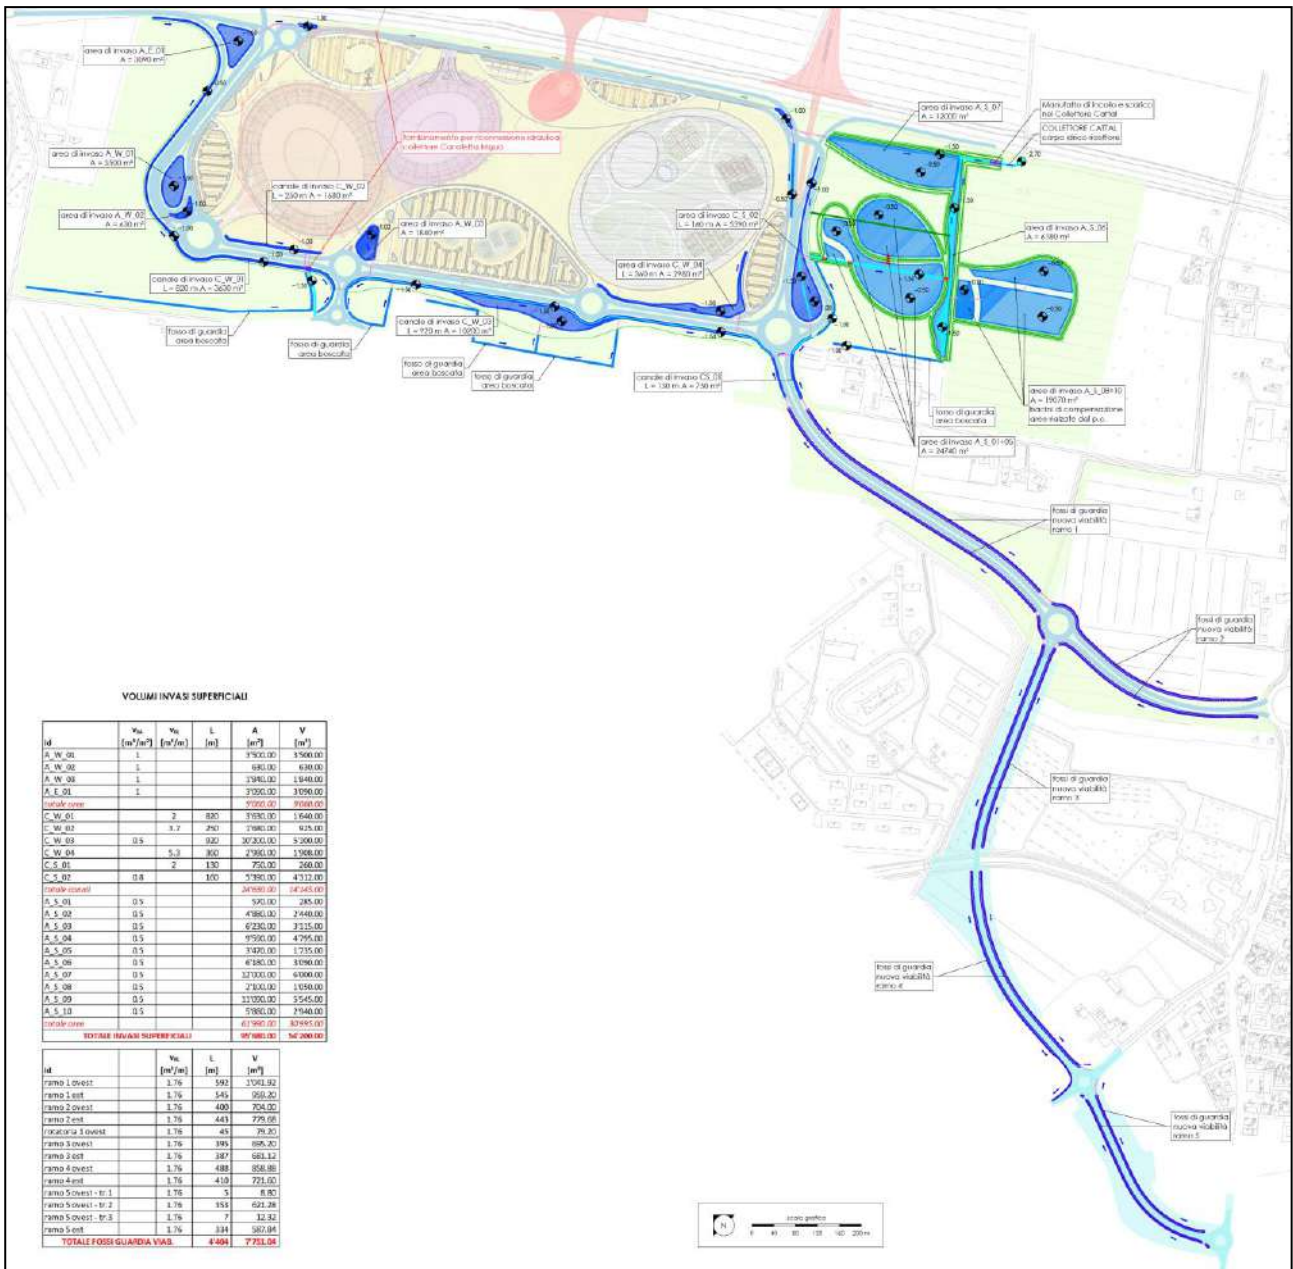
Opere di compensazione - Planimetria degli invasi superficiali
